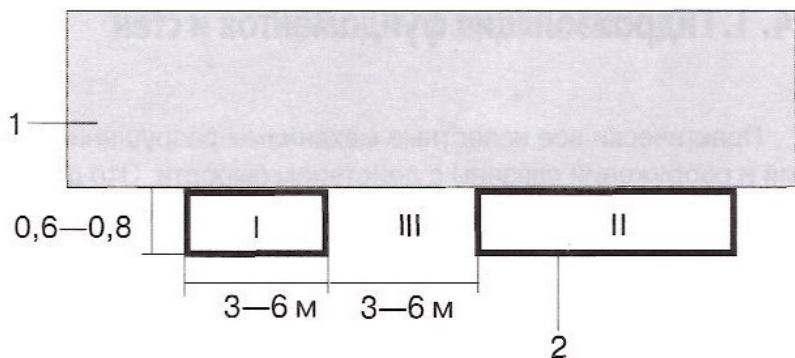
Схема виконання робіт по влаштуванню вертикальної гідроізоляції існуючої будівлі:
